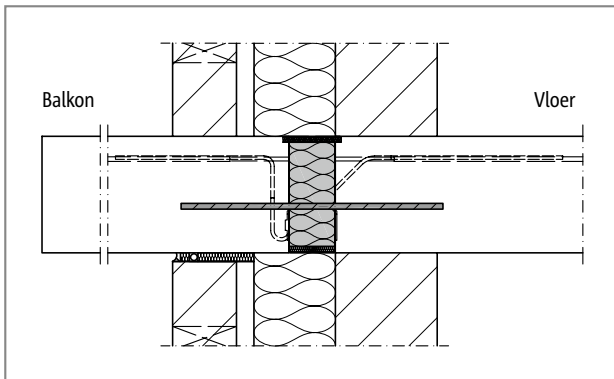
Schöck Isokorb® T type H: Ondersteund balkon
